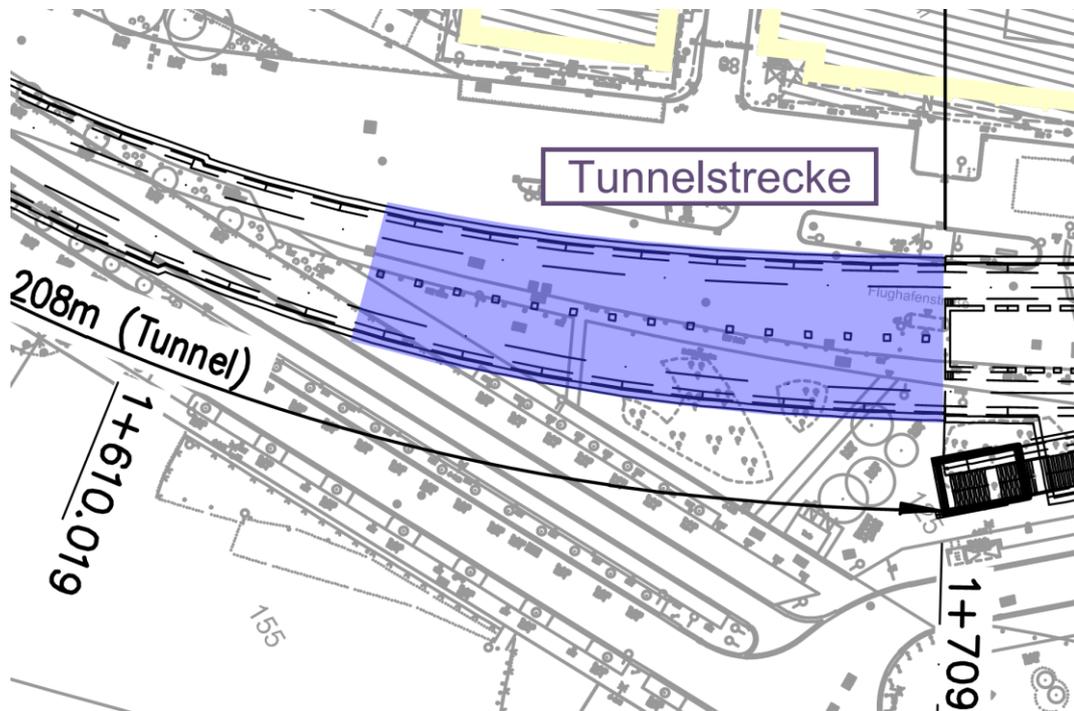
Übersicht der Baugrube „Tunnelstrecke“
